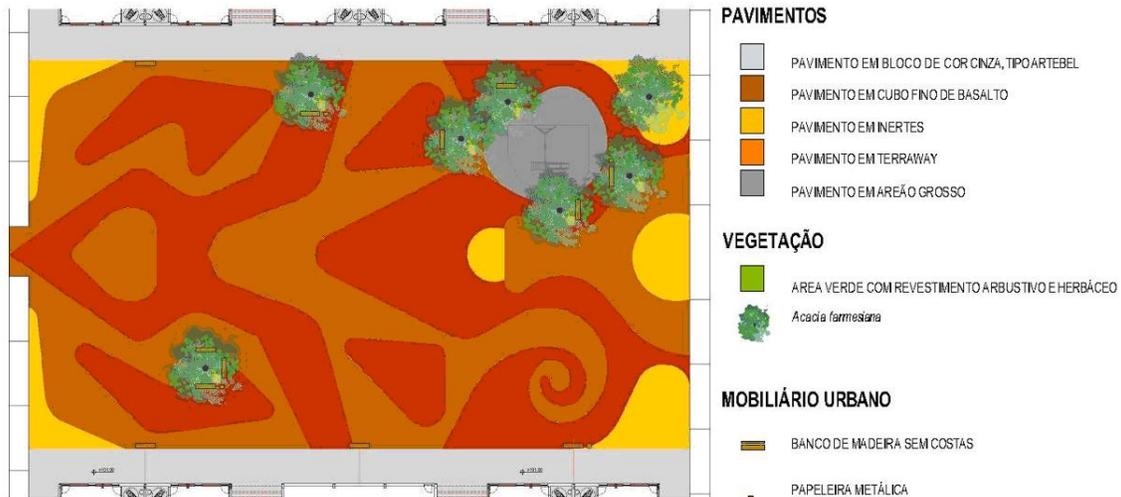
Extrato da planta de espaços abertos, da zona da praça onde o desenho de pavimentos foi explorado, onde por razões de orientação solar e amenidade se localizou o equipamento infantil e árvore na extremidade da praça – realizado à escala 1/200 (imagem apresentada sem escala).
